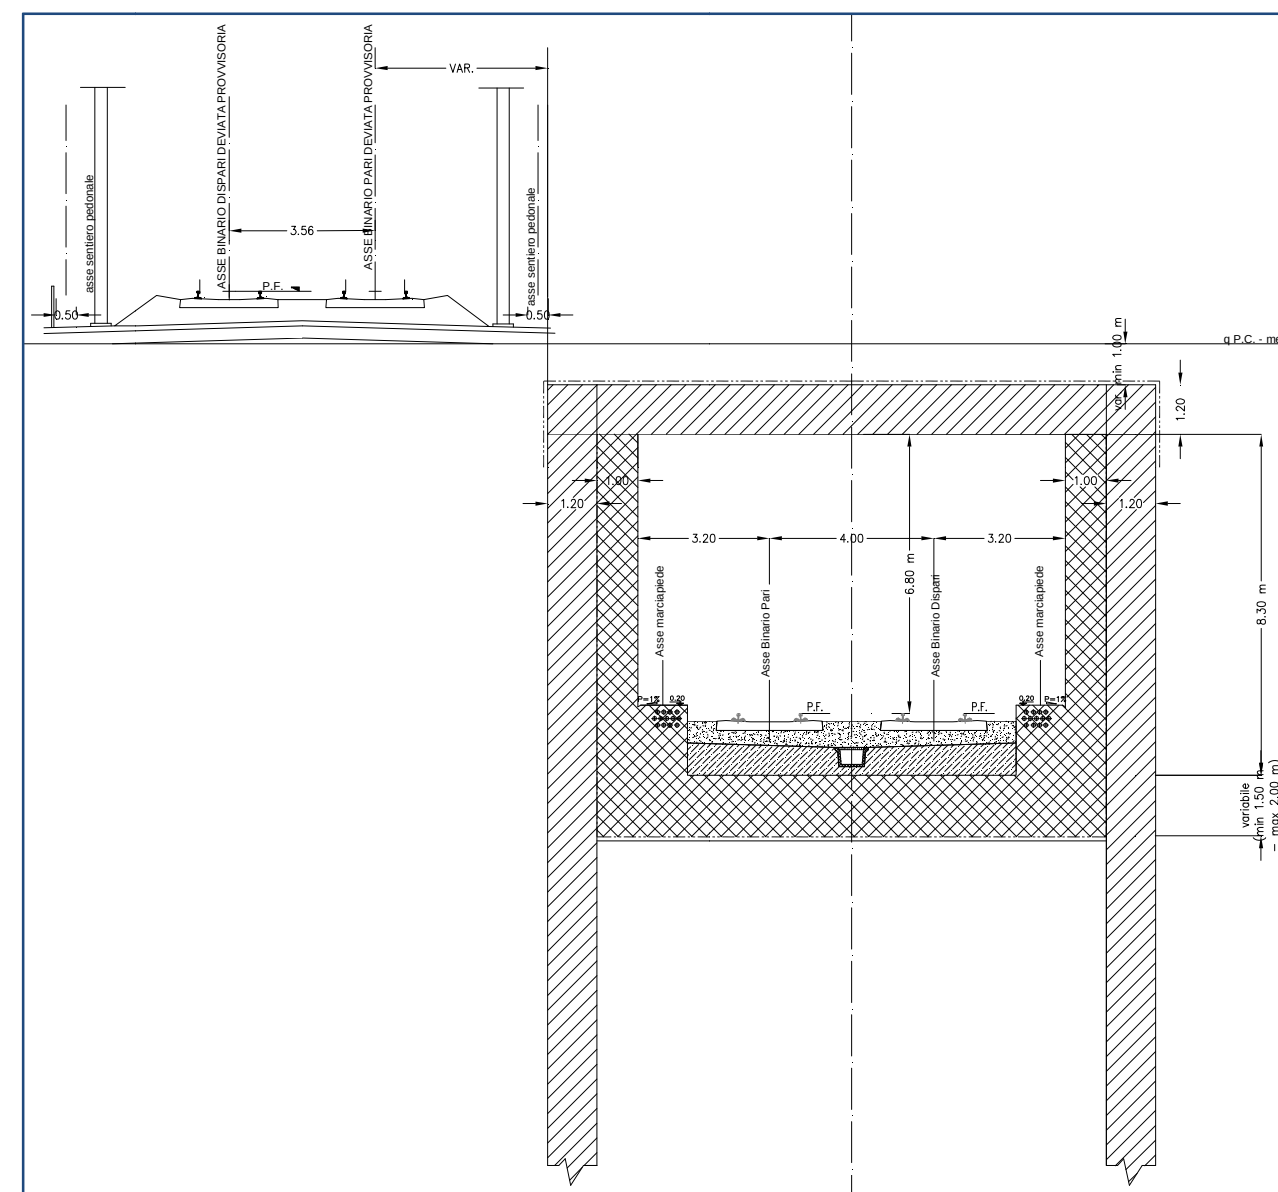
Soluzione 1 – Sezione trasversale fase 2
